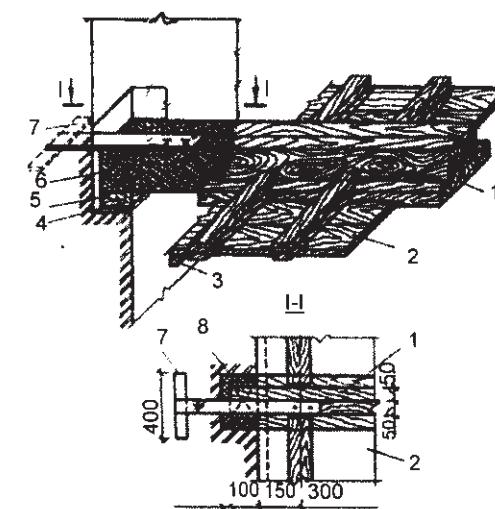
Узел опирания деревянных балок и щитов на наружные стены из кирпича
